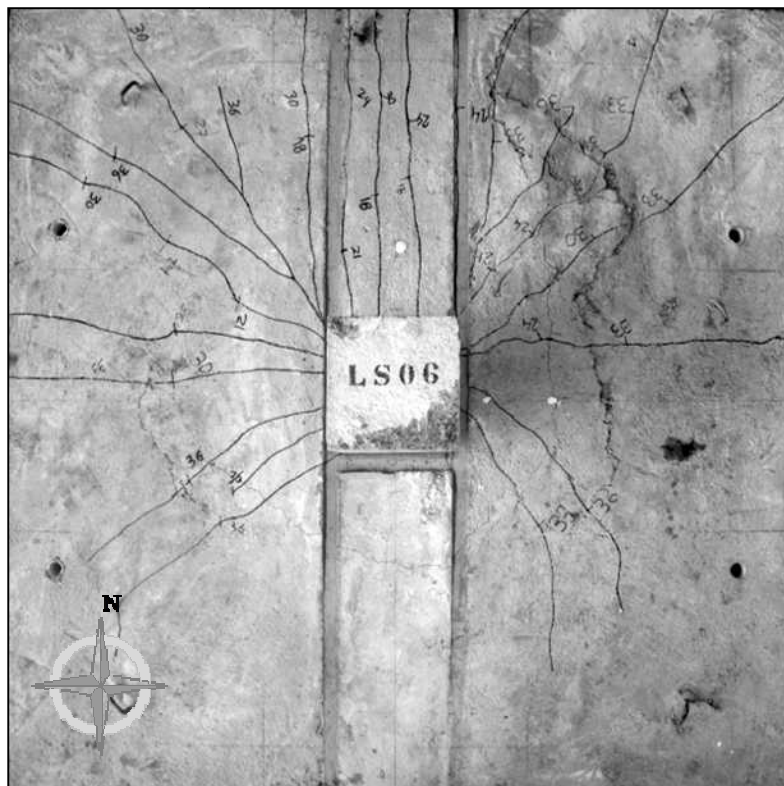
Mapa de fissuração da laje LS06
